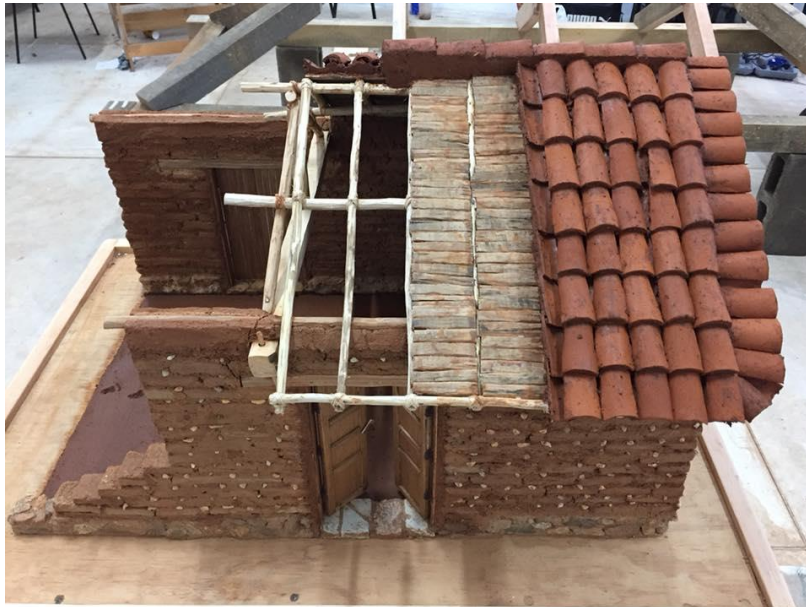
Obtenida de (Laboratorio de Procedimientos y Sistemas Constructivos Tradicionales, 2019). Maqueta de detalles constructivos. Vivienda vernácula con muros de adobe
